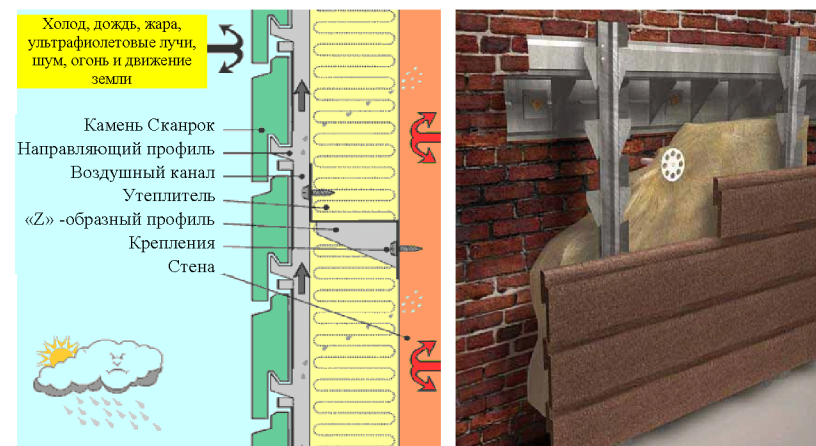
Схема вентилируемого фасада СКАНРОК
